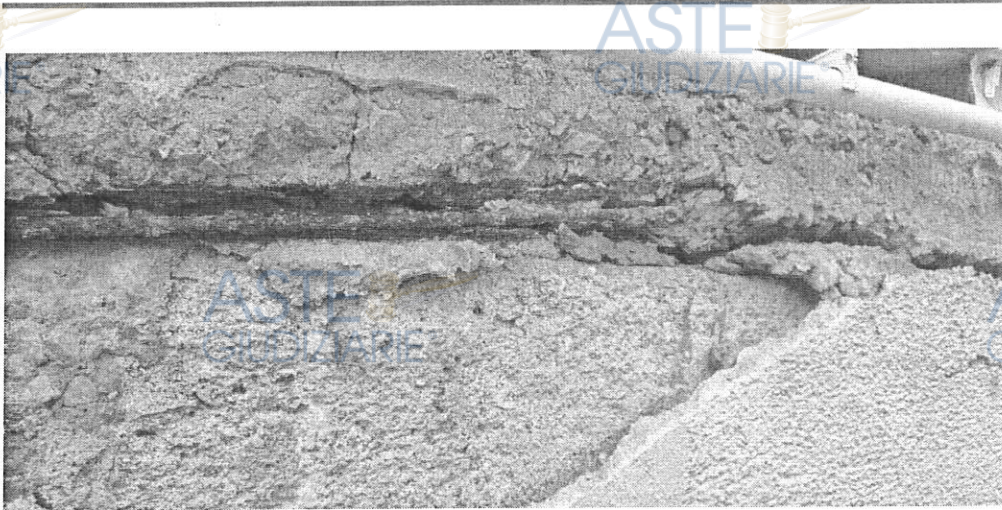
Ossidazione delle barre di armatura sul muretto d'attico
